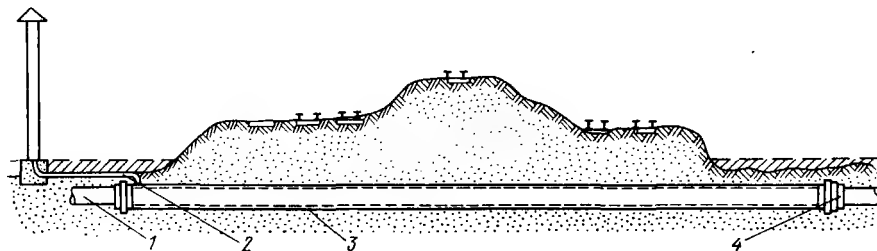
Схема пересечения газопроводами высокого и среднего давления железнодорожных путей.
